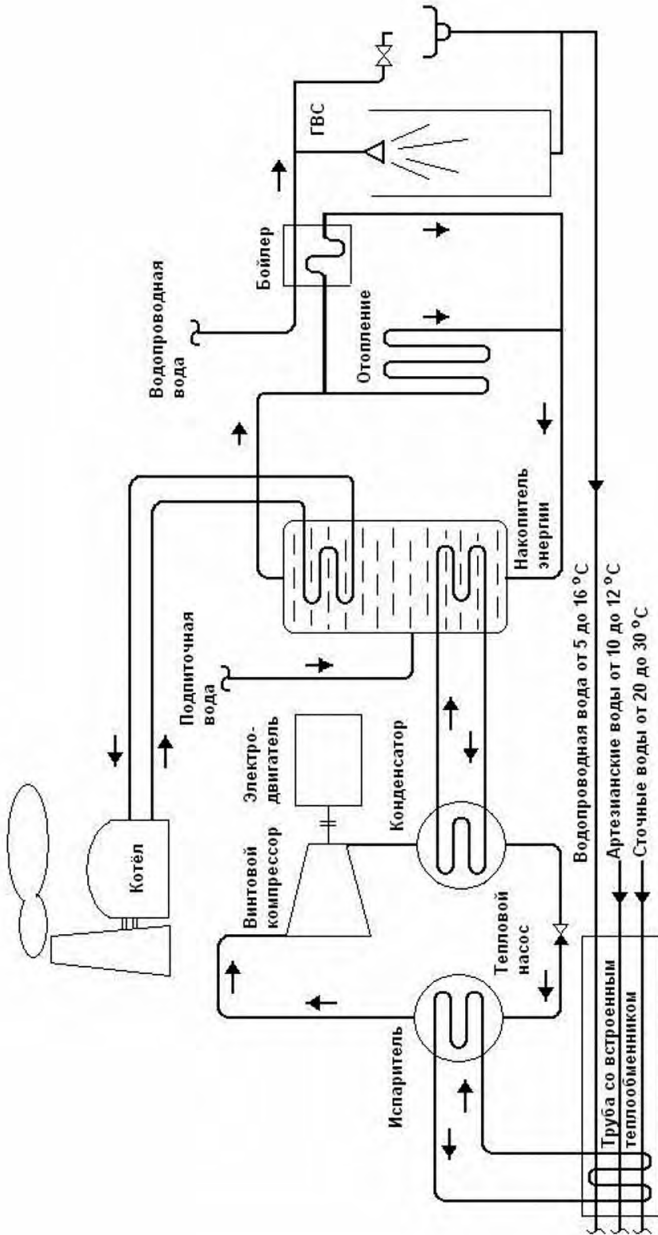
Схема отопления и горячего водоснабжения с использованием теплового насоса и котельной
